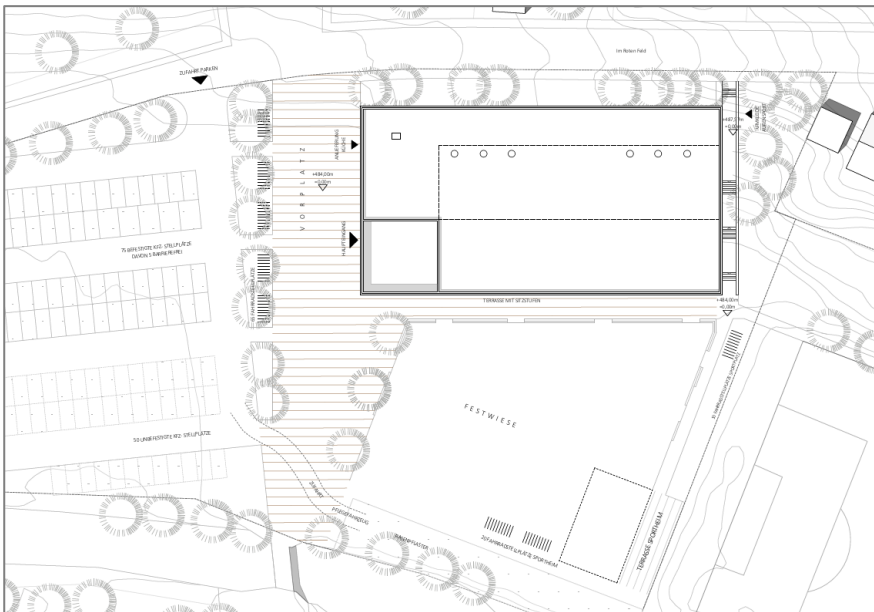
Ausschnitt Lageplan des Bauvorhabens
